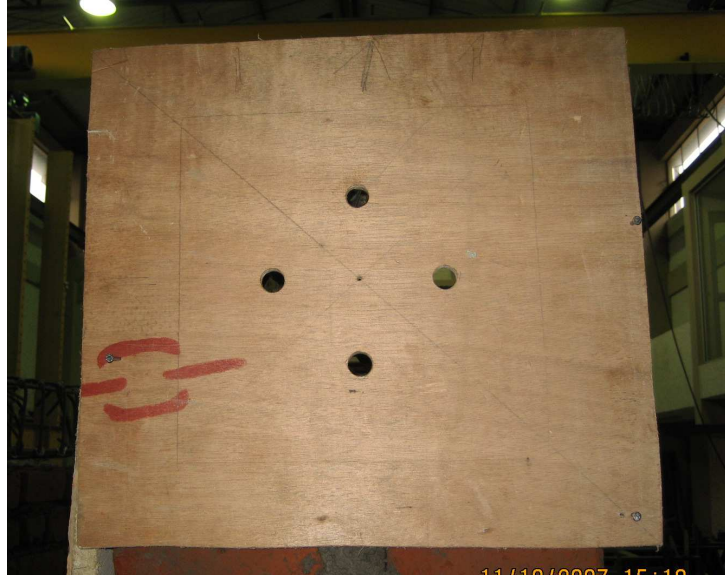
Detalle del encofrado de la viga superior.
